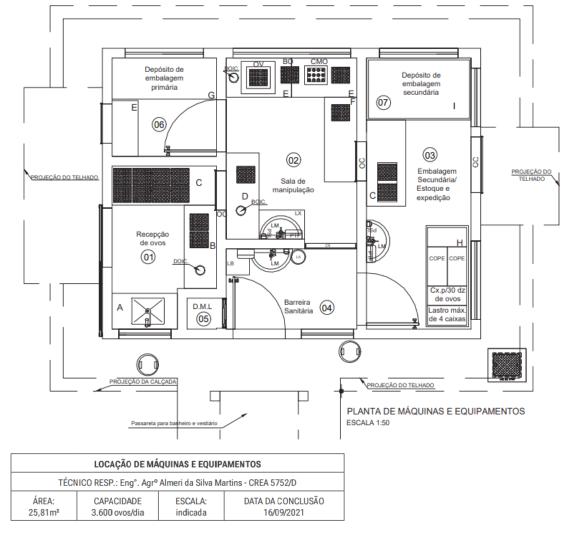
Planta com disposição de Máquinas e Equipamentos de uma granja avícola.
